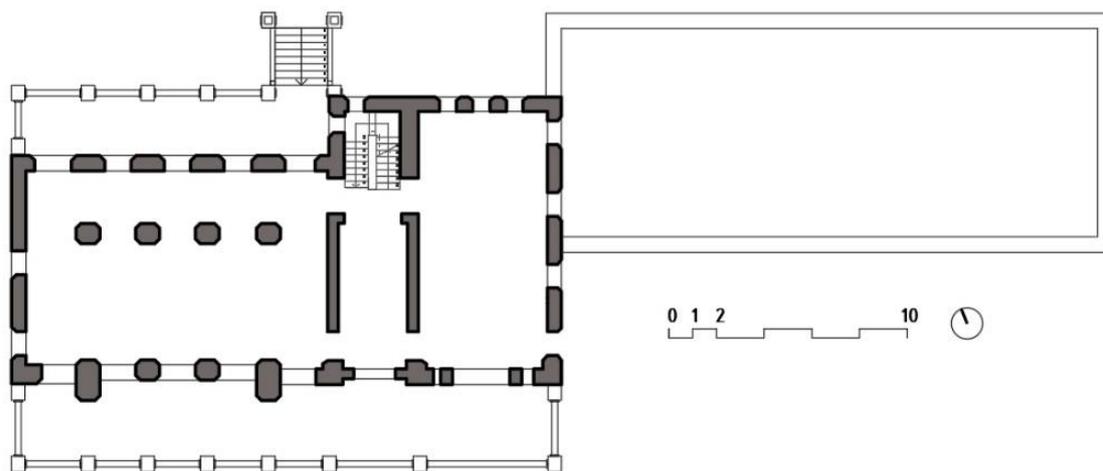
Sanatorio de Cesuras, planta baja. Elaboración propia
